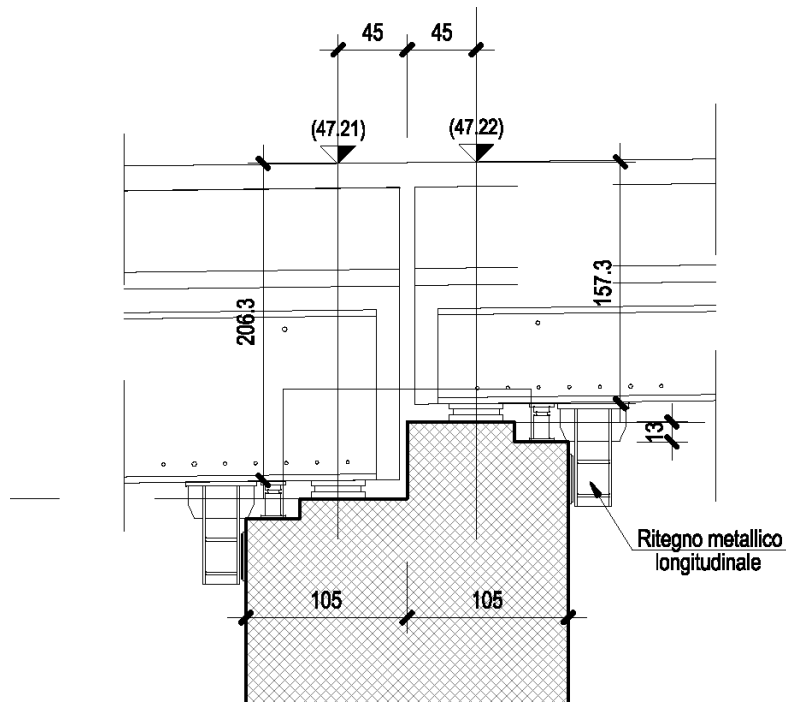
Pila, prospetto longitudinale – Due impalcati a travi incorporate
